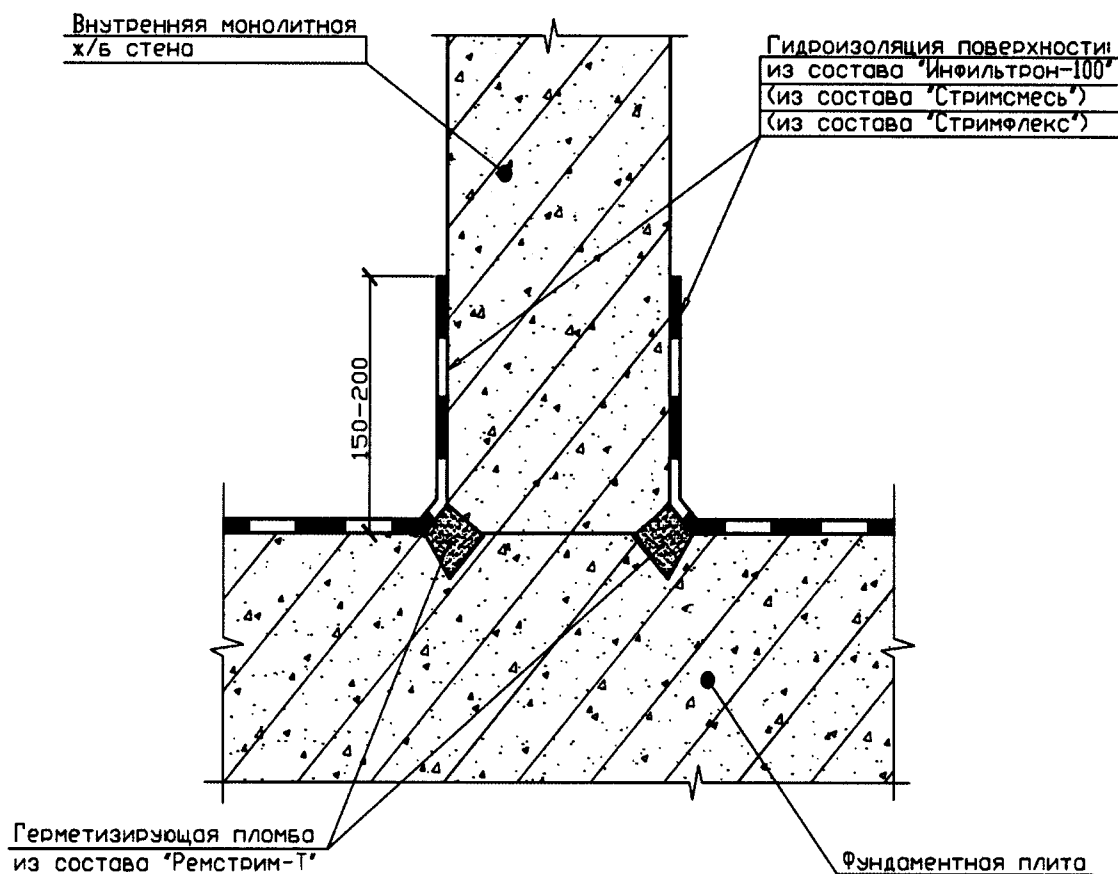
Гидроизоляция поверхностей монолитных железобетонных конструкций. Гидроизоляция поверхностей внутренних стен в зоне примыкания к фундаментной плите
